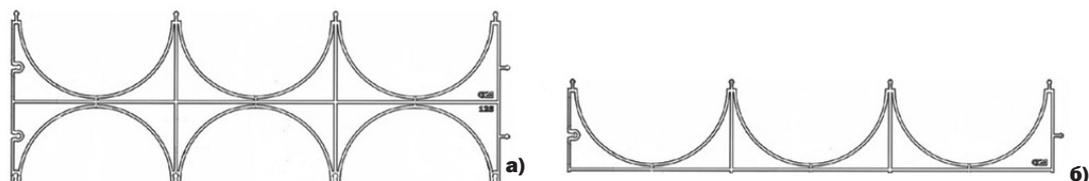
Опорный кластер для нижнего ряда труб в сложных грунтах:
